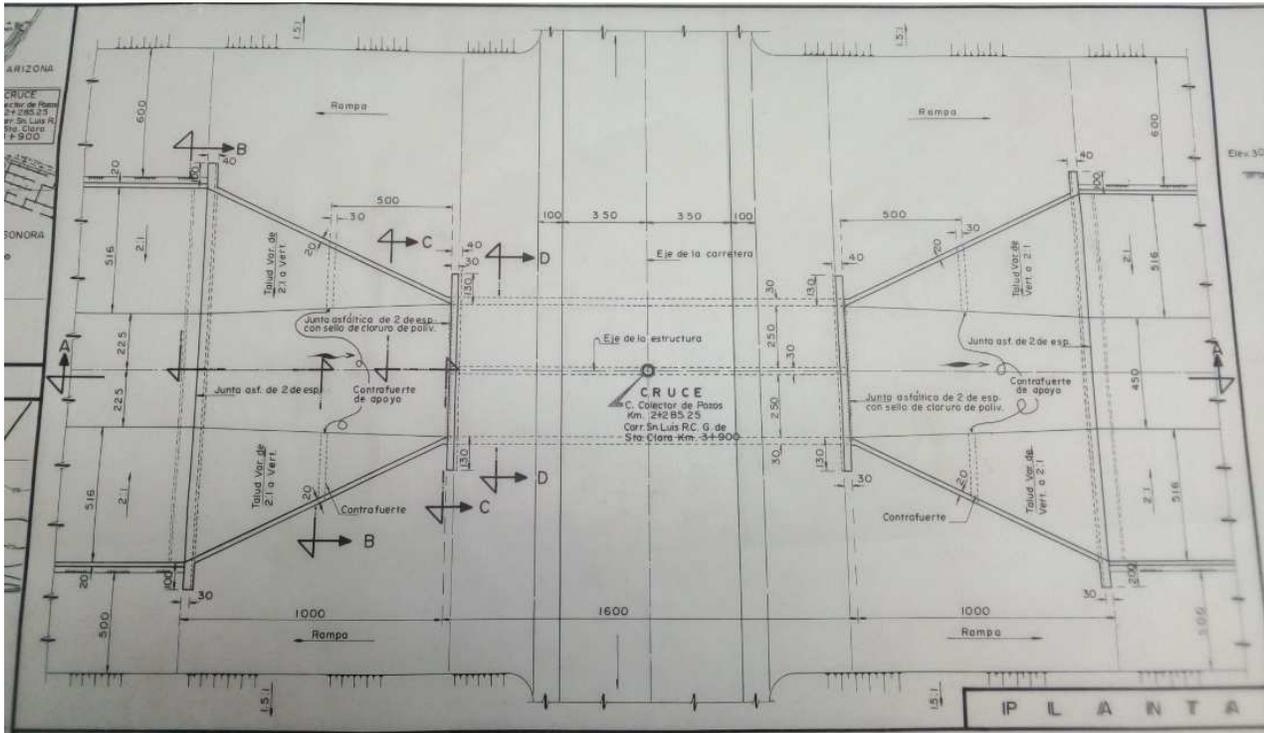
Detalle en planta de la sección de la alcantarilla en el cruce de la carretera
